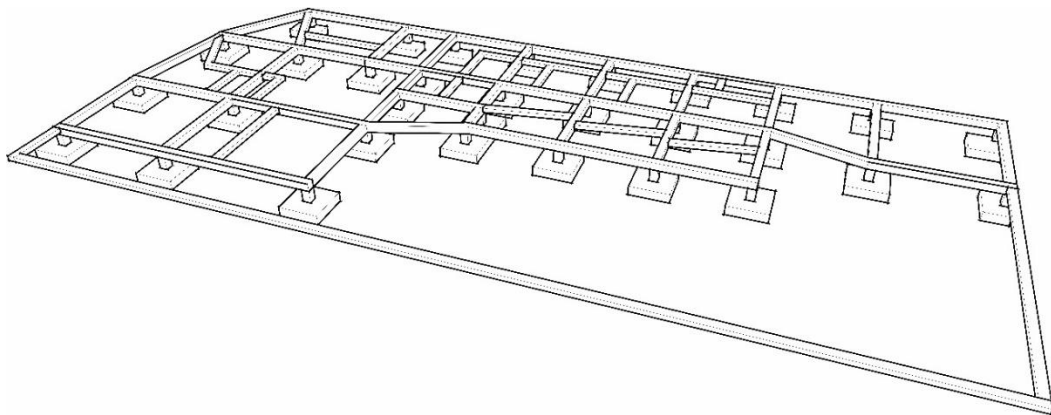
Propuesta de cimentación estructural. Zapatas aisladas.
